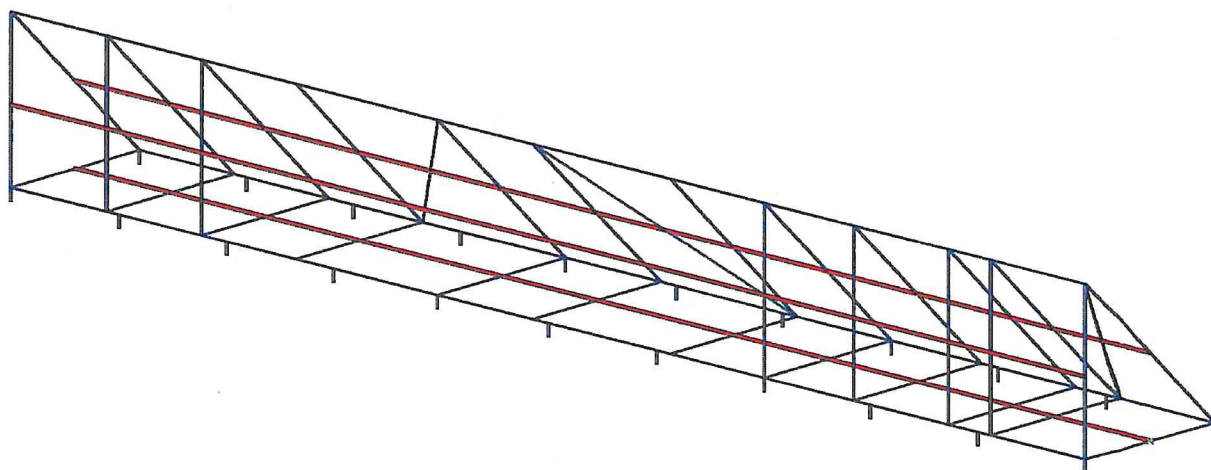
Upravená konstrukce – červené nové ztužující prvky
